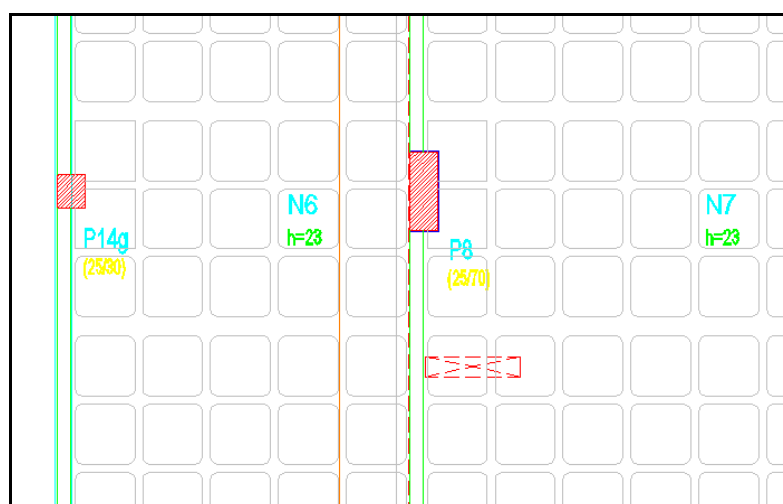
Falta de dimensionamento do shaft na laje no pavimento play ground
